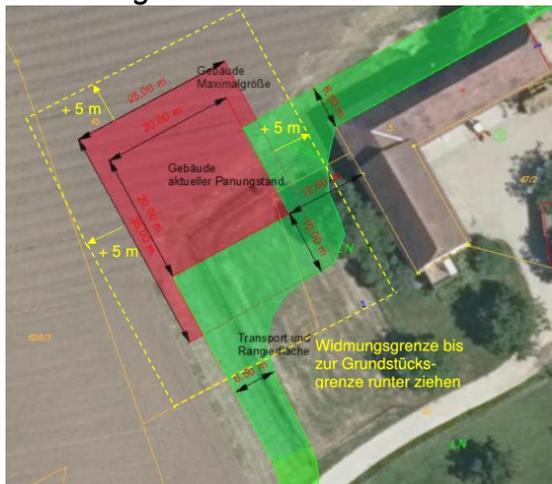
Entwurfsplan der Erstellung einer Biomasseheizanlagen in Rot mit Darstellung der Transport- und Rangierflächen in Grün vom 11.2021, Quelle: Rudolf Hofmann und Stadtgemeinde Enns.
